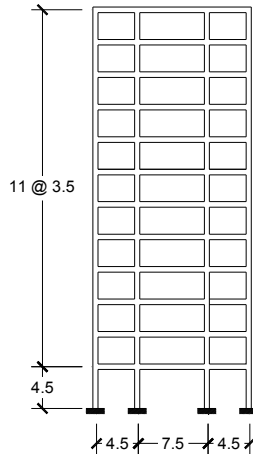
Geometría del marco plano irregular en planta de doce niveles (dimensiones en metros)
